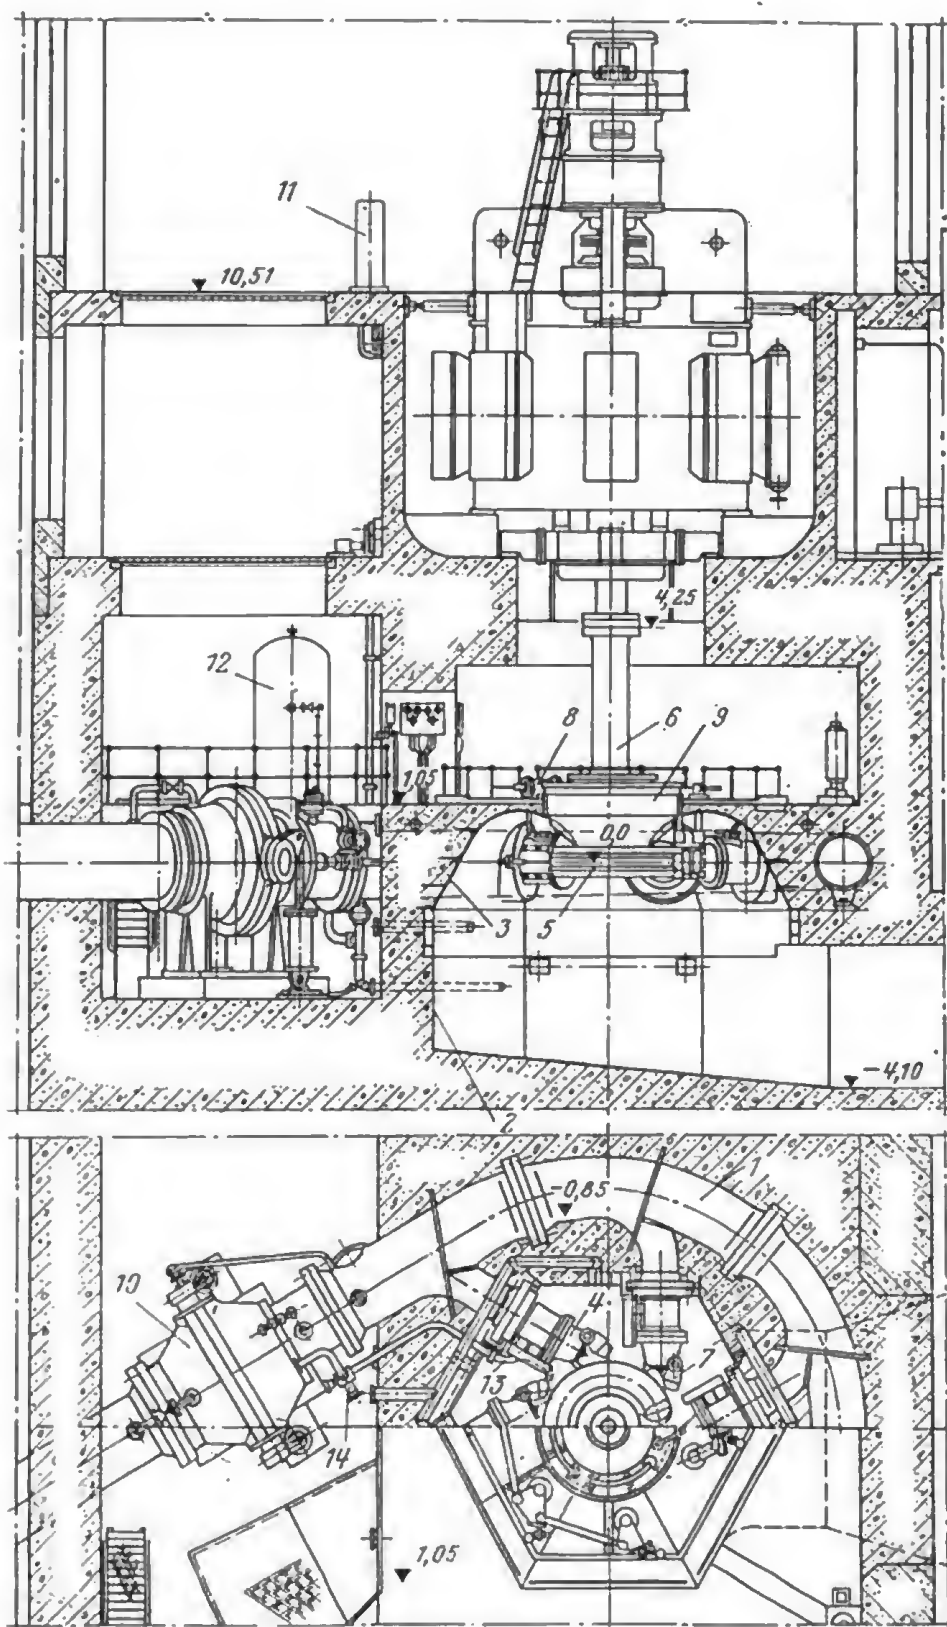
Вертикальный гидроагрегат с ковшовой турбиной.
